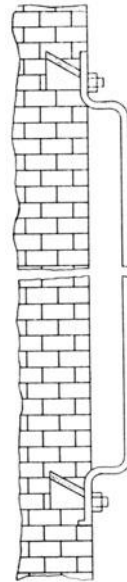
Eiserne Führung für den Senkschacht. (Aus dem „Sammelwerk“, Band III.)
